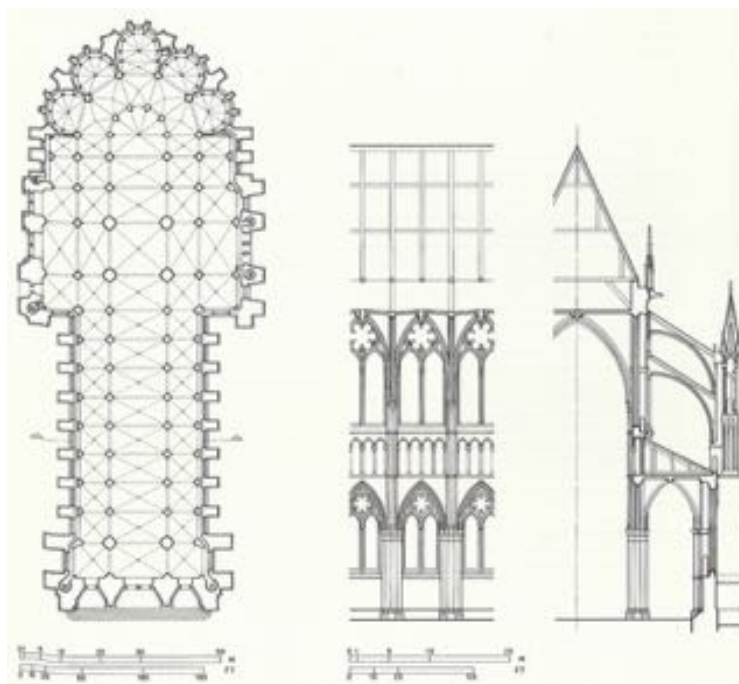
Reims, Kathedrale Notre Dame; Grundriss, Wandaufriss im Langhaus und Querschnitt
